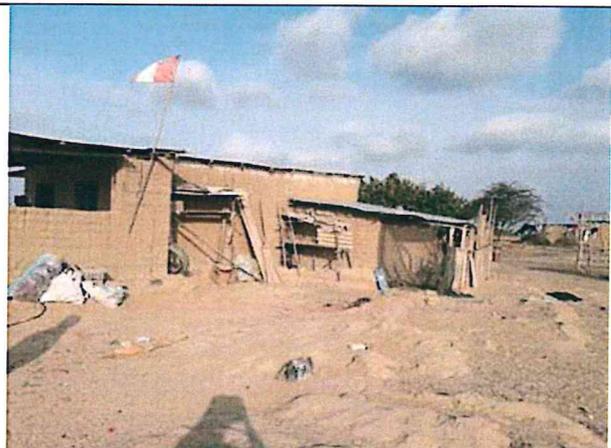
Vivienda de adobe y techo de calamina, en regular estado de conservación.
